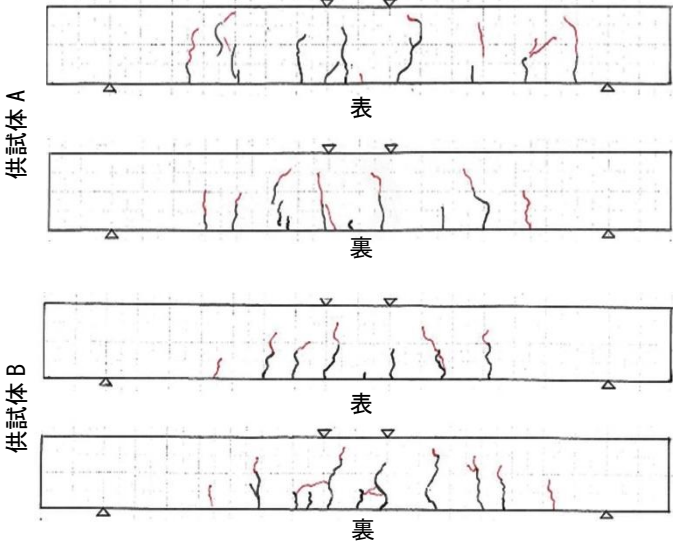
ひび割れ図（供試体 A および B, 40kN 時）
